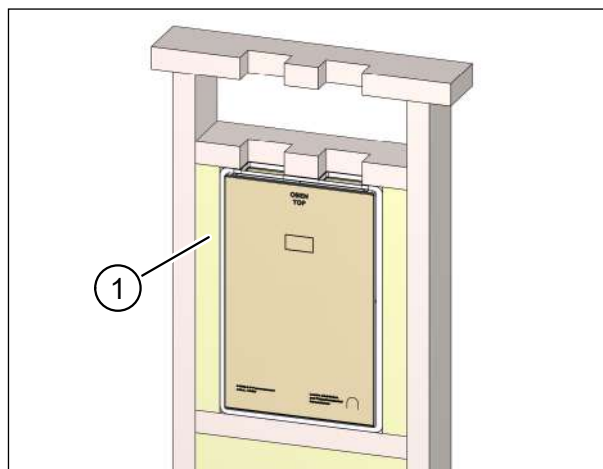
Riempimento delle cavità intorno alla cassetta a muro con materiale isolante
